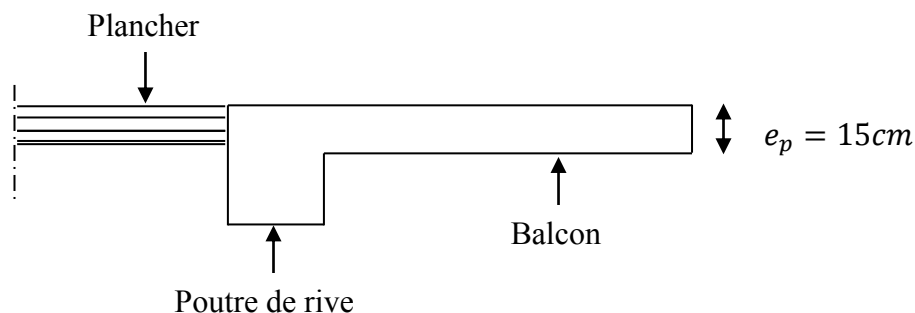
Coupe verticale détaillant la liaison balcon – poutre.
